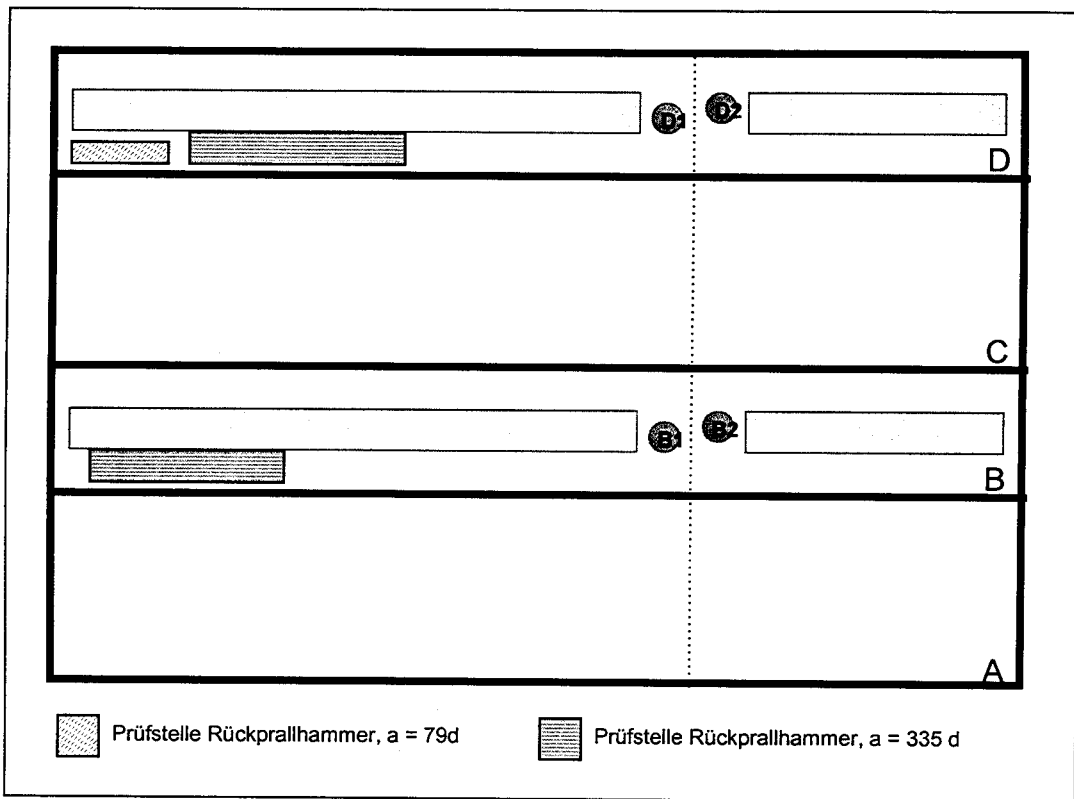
Lage der Prüfflächen am Betonkörper 15
